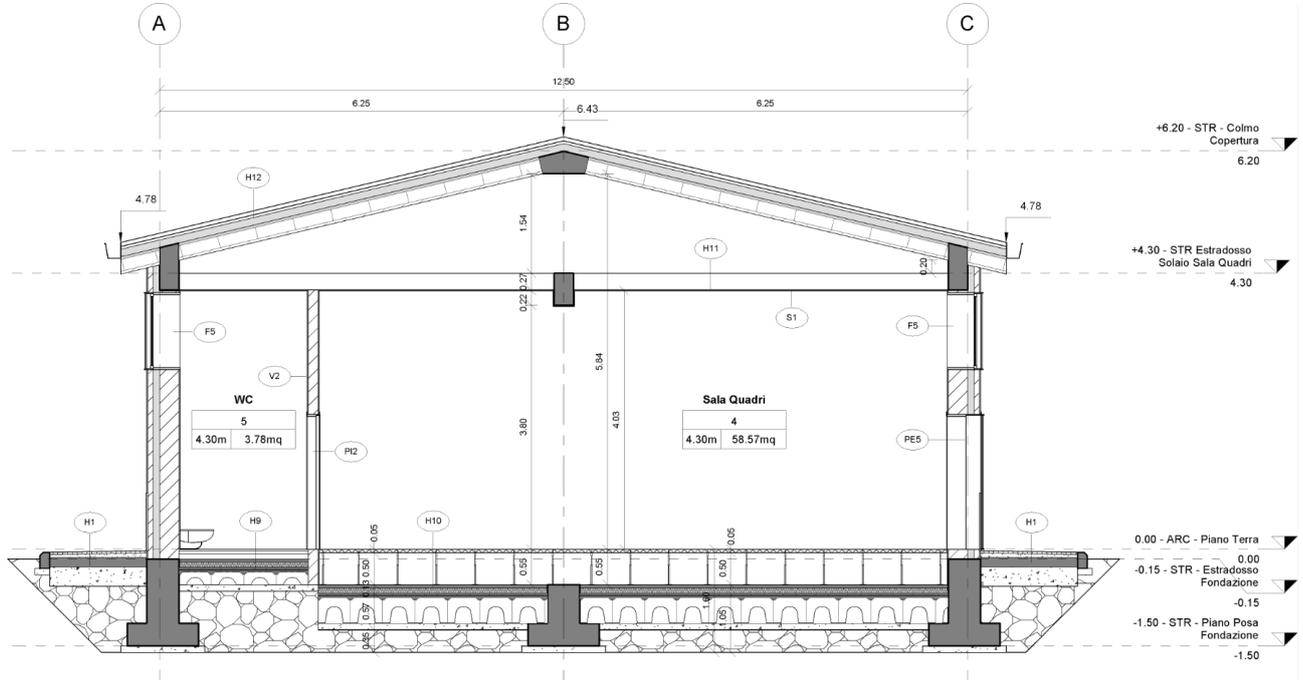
SSE Pieve Emanuele - Sezione B – B
